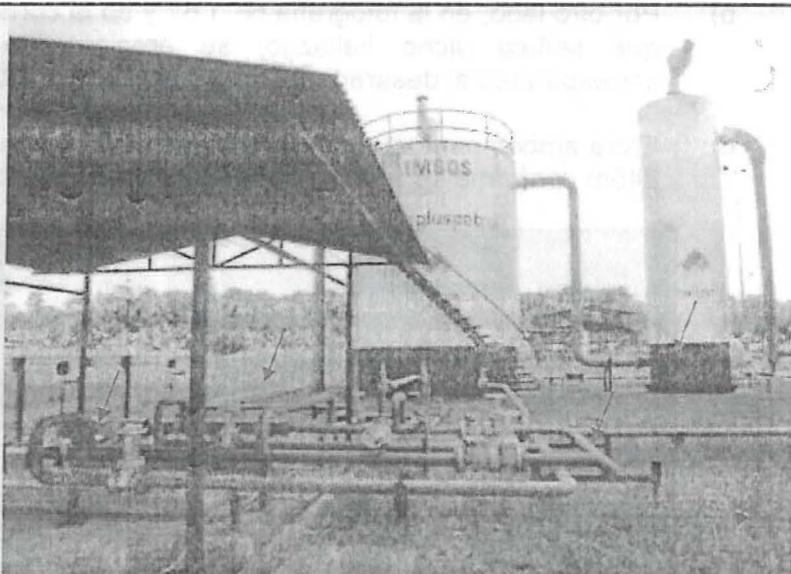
Sistema desarenador de agua de inyección, batería 2(N 9576871, 492808E).
